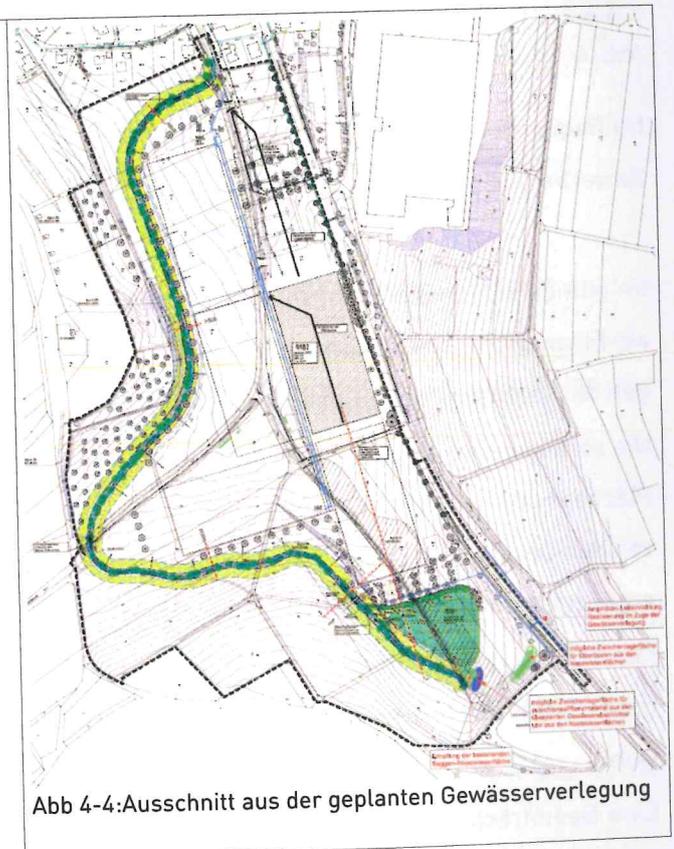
Ausschnitt aus der geplanten Gewässerverlegung
